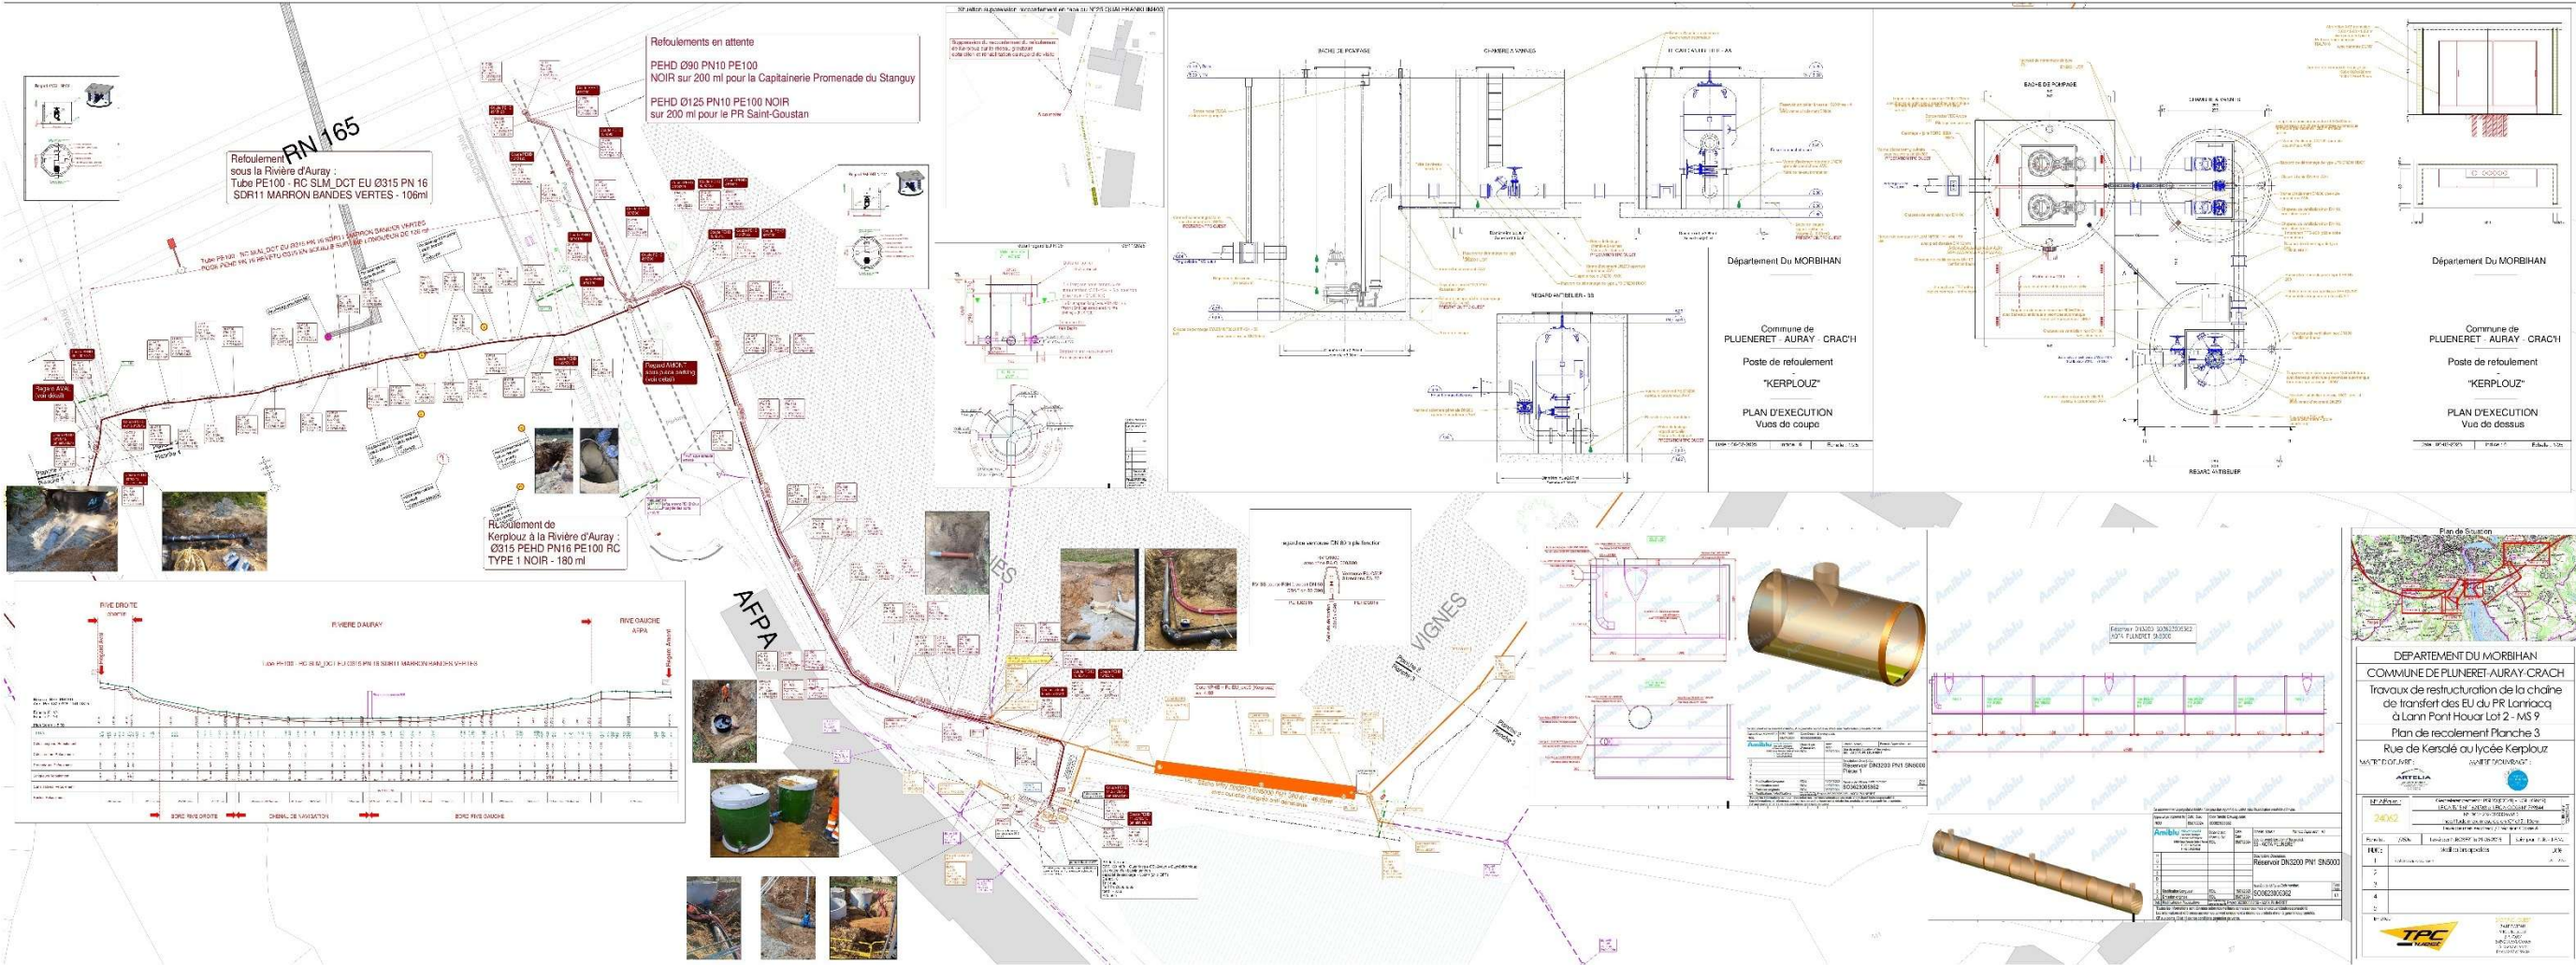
Plan de recollement de la traversée de la canalisation dans la rivière d'Auray
